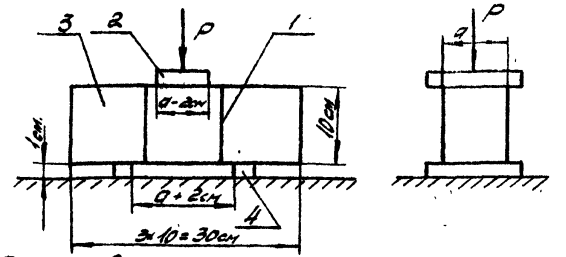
Схема испытания контрольных образцов. 1 - клеевые стыки; 2 - распределительная стальная плита; 3 - бетонные кубы; 4 - стальные подкладки.
